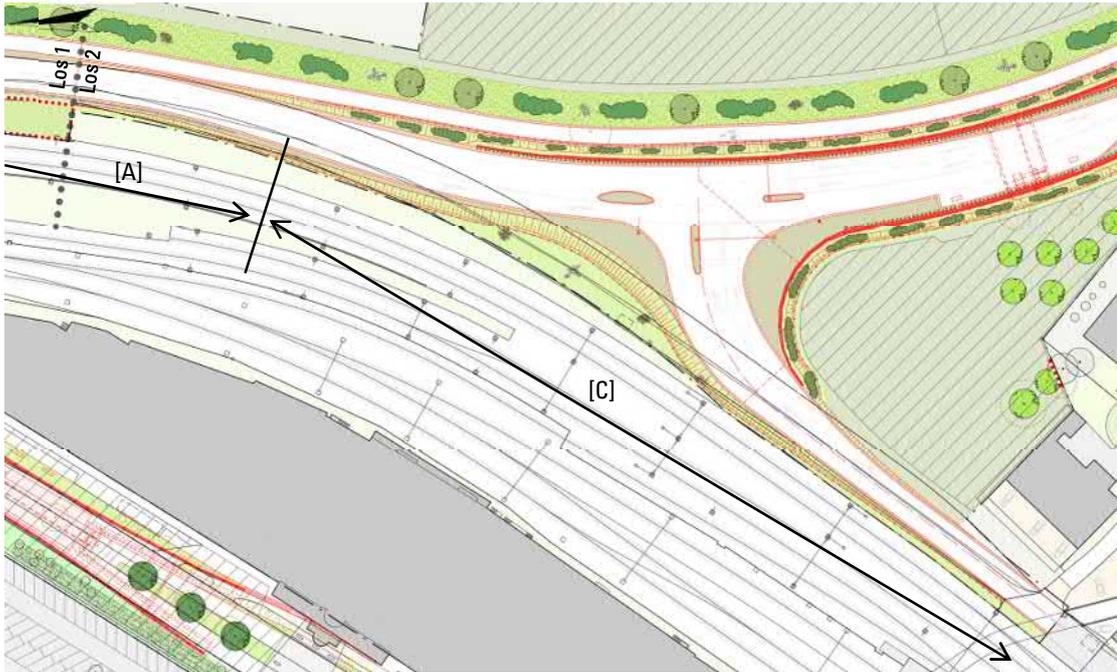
Planausschnitt: Böschung entlang AVA
